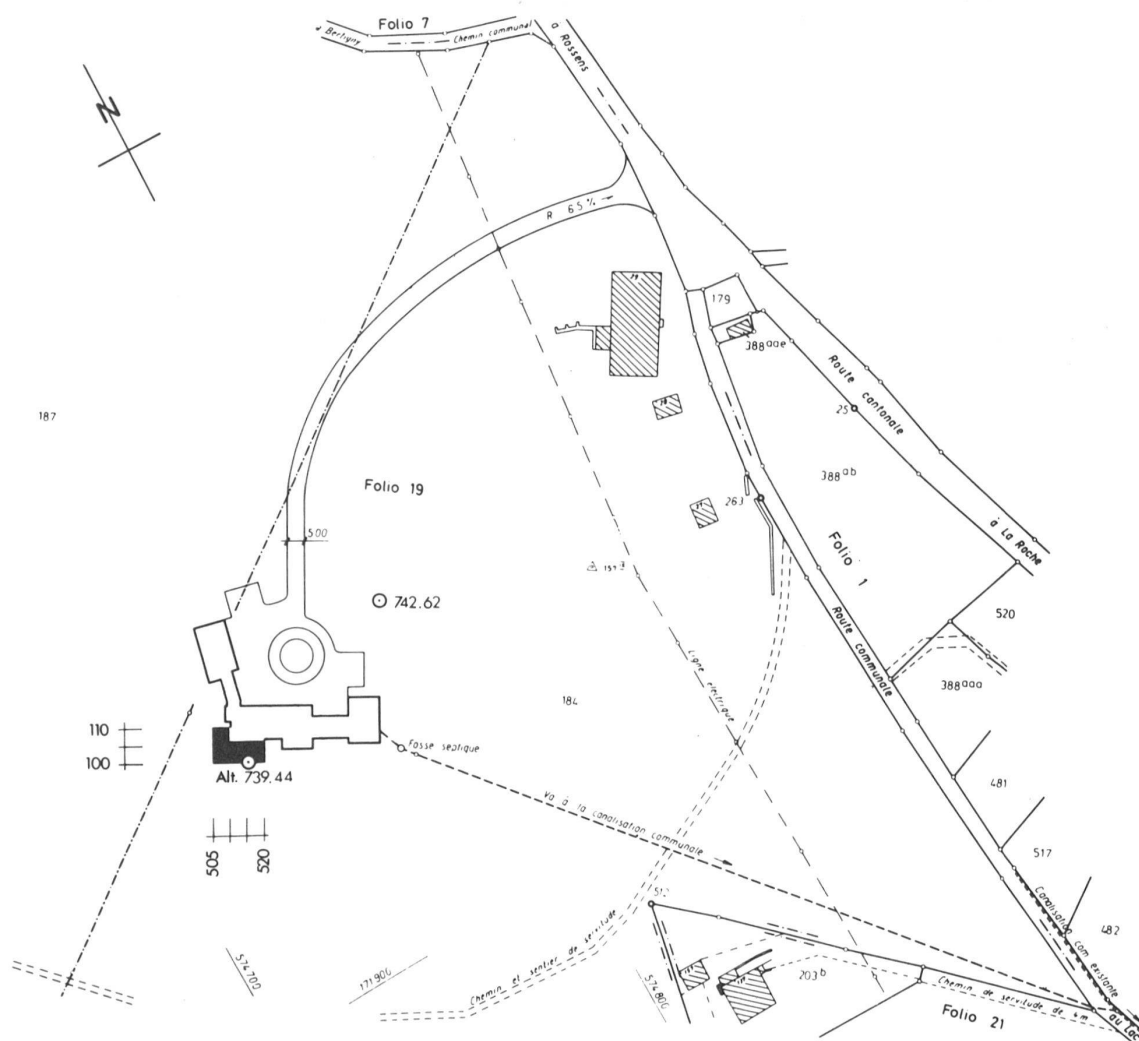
Plan cadastral (folio 19), commune de Pont-la-Ville (1:2000)
